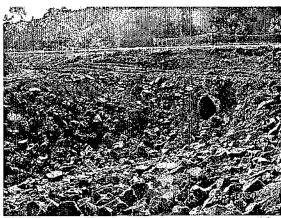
Enrocamento em bueiro rompido – Lote 01.
